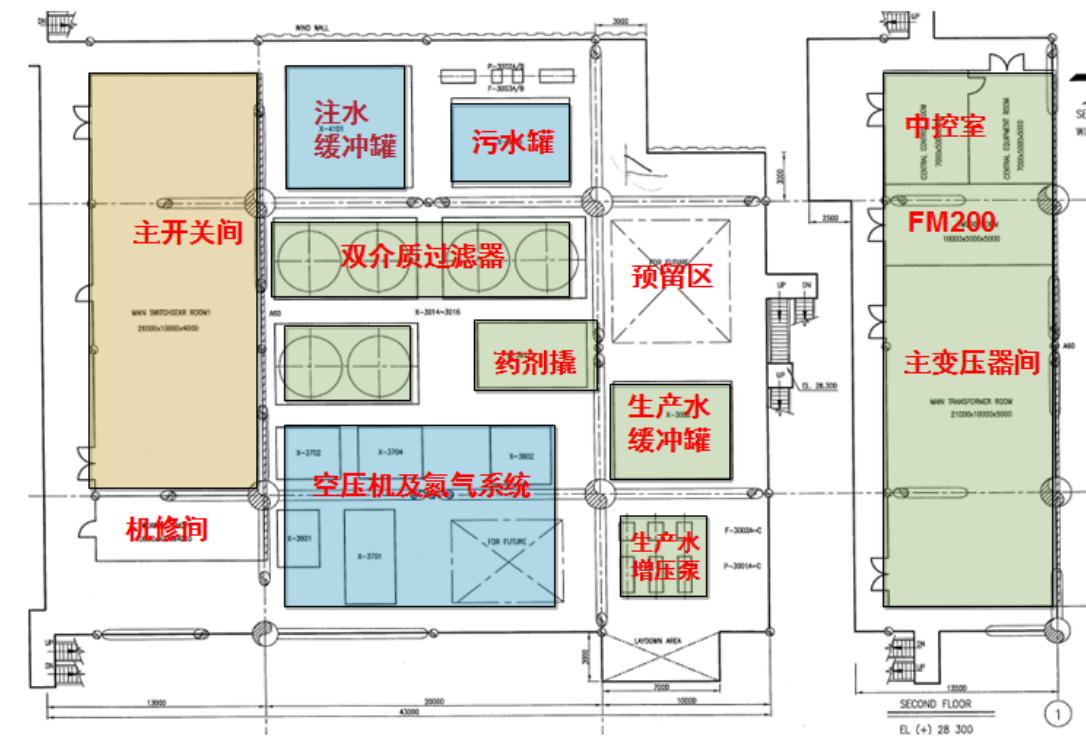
QHD32-6CEPL 平台中层甲板平面布置图
